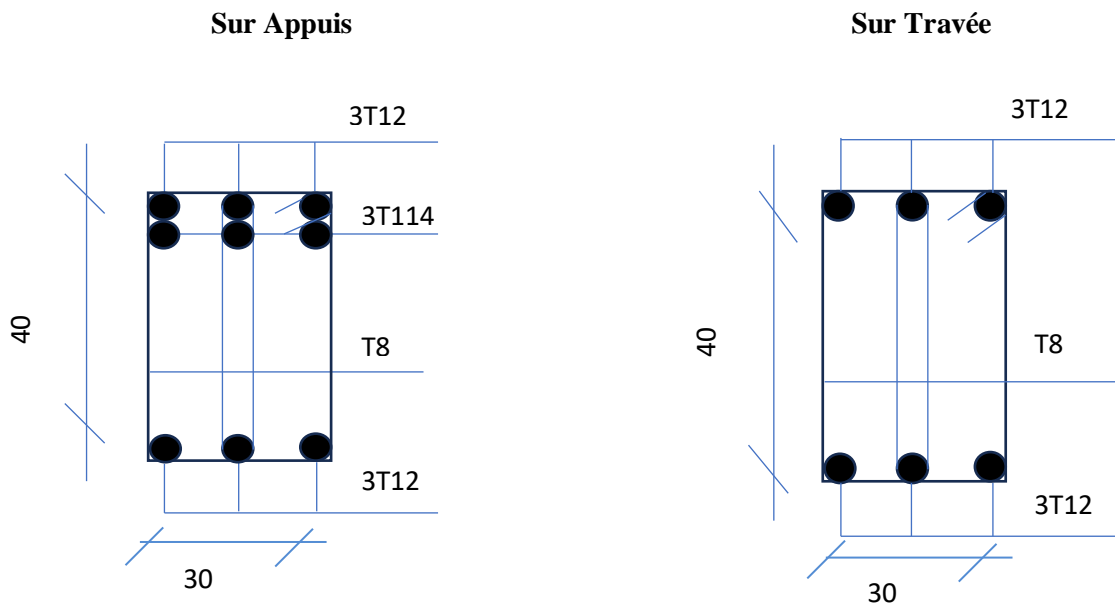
Coupe de ferrailage des poutres secondaires au niveau d'appuis et travée.
